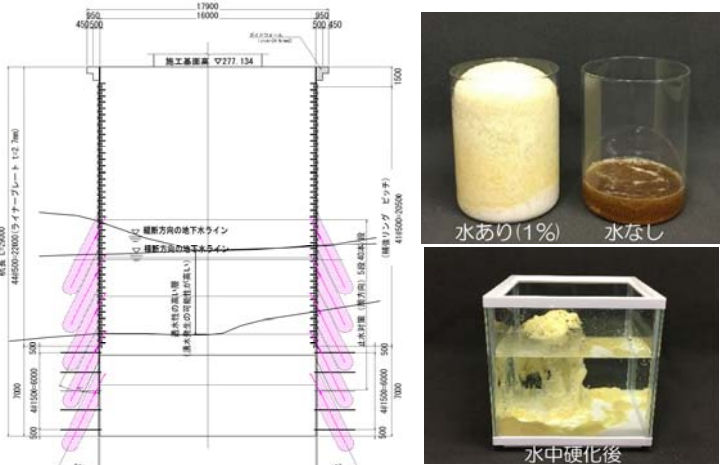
大口径深礎杭概要図 写真-2 ウレタン系湧水抑制材
